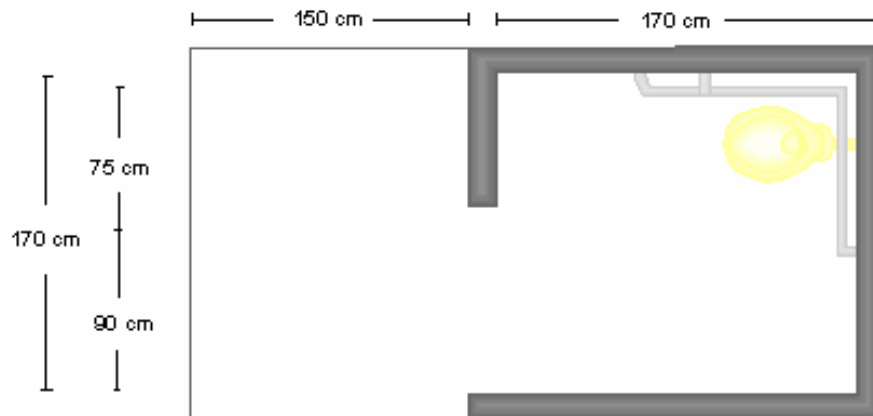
VISTA SUPERIOR DEL BAÑO.
